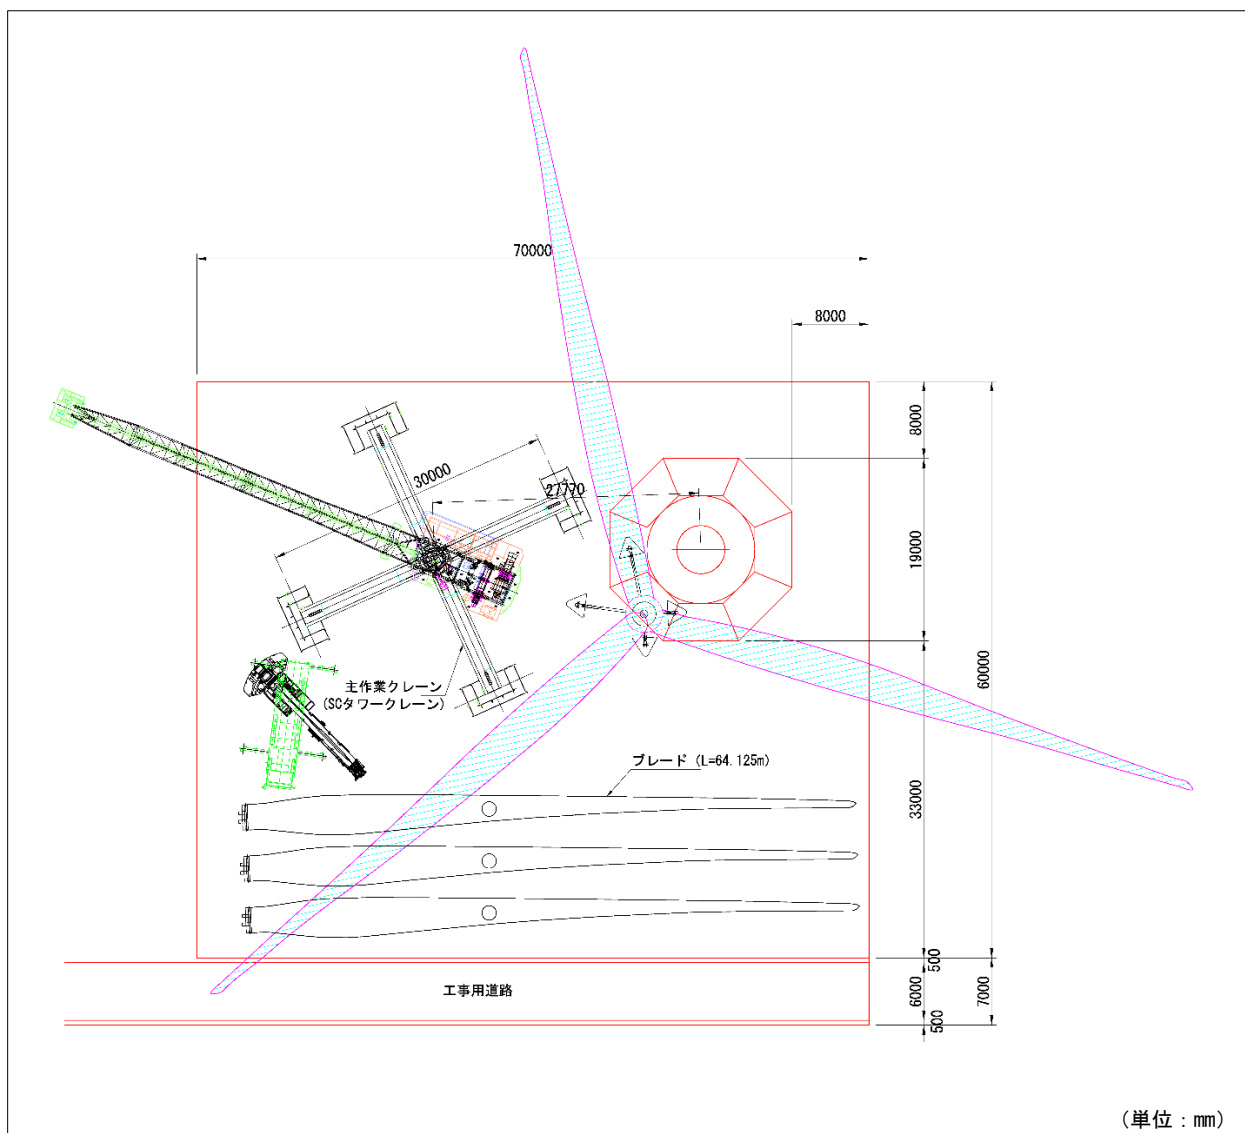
(1) 風力発電機ヤードの平面図 (例)
